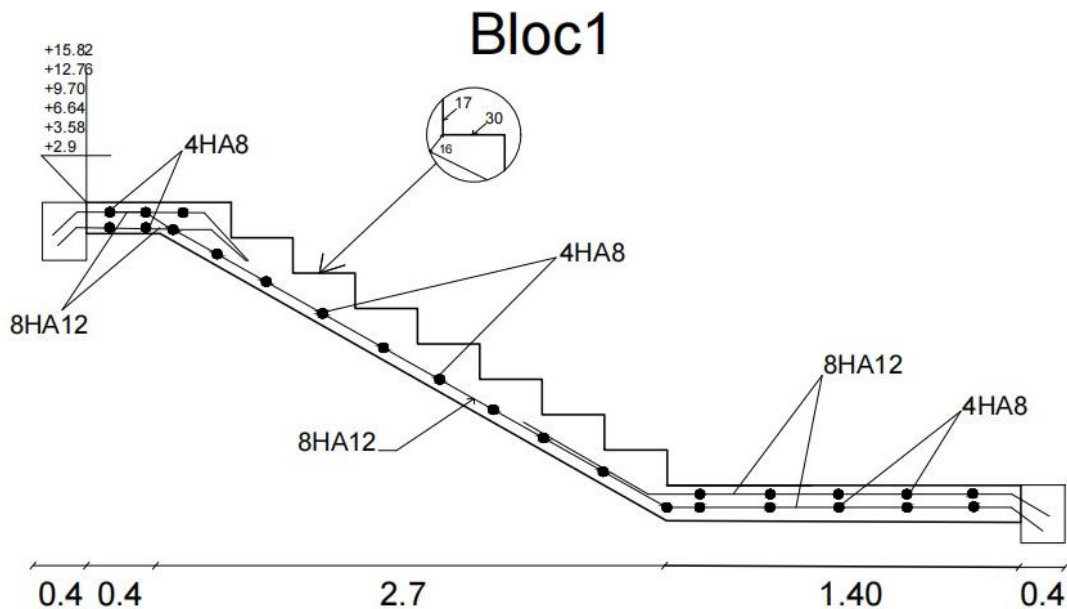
Schéma du ferrailage d'escalier bloc1.
